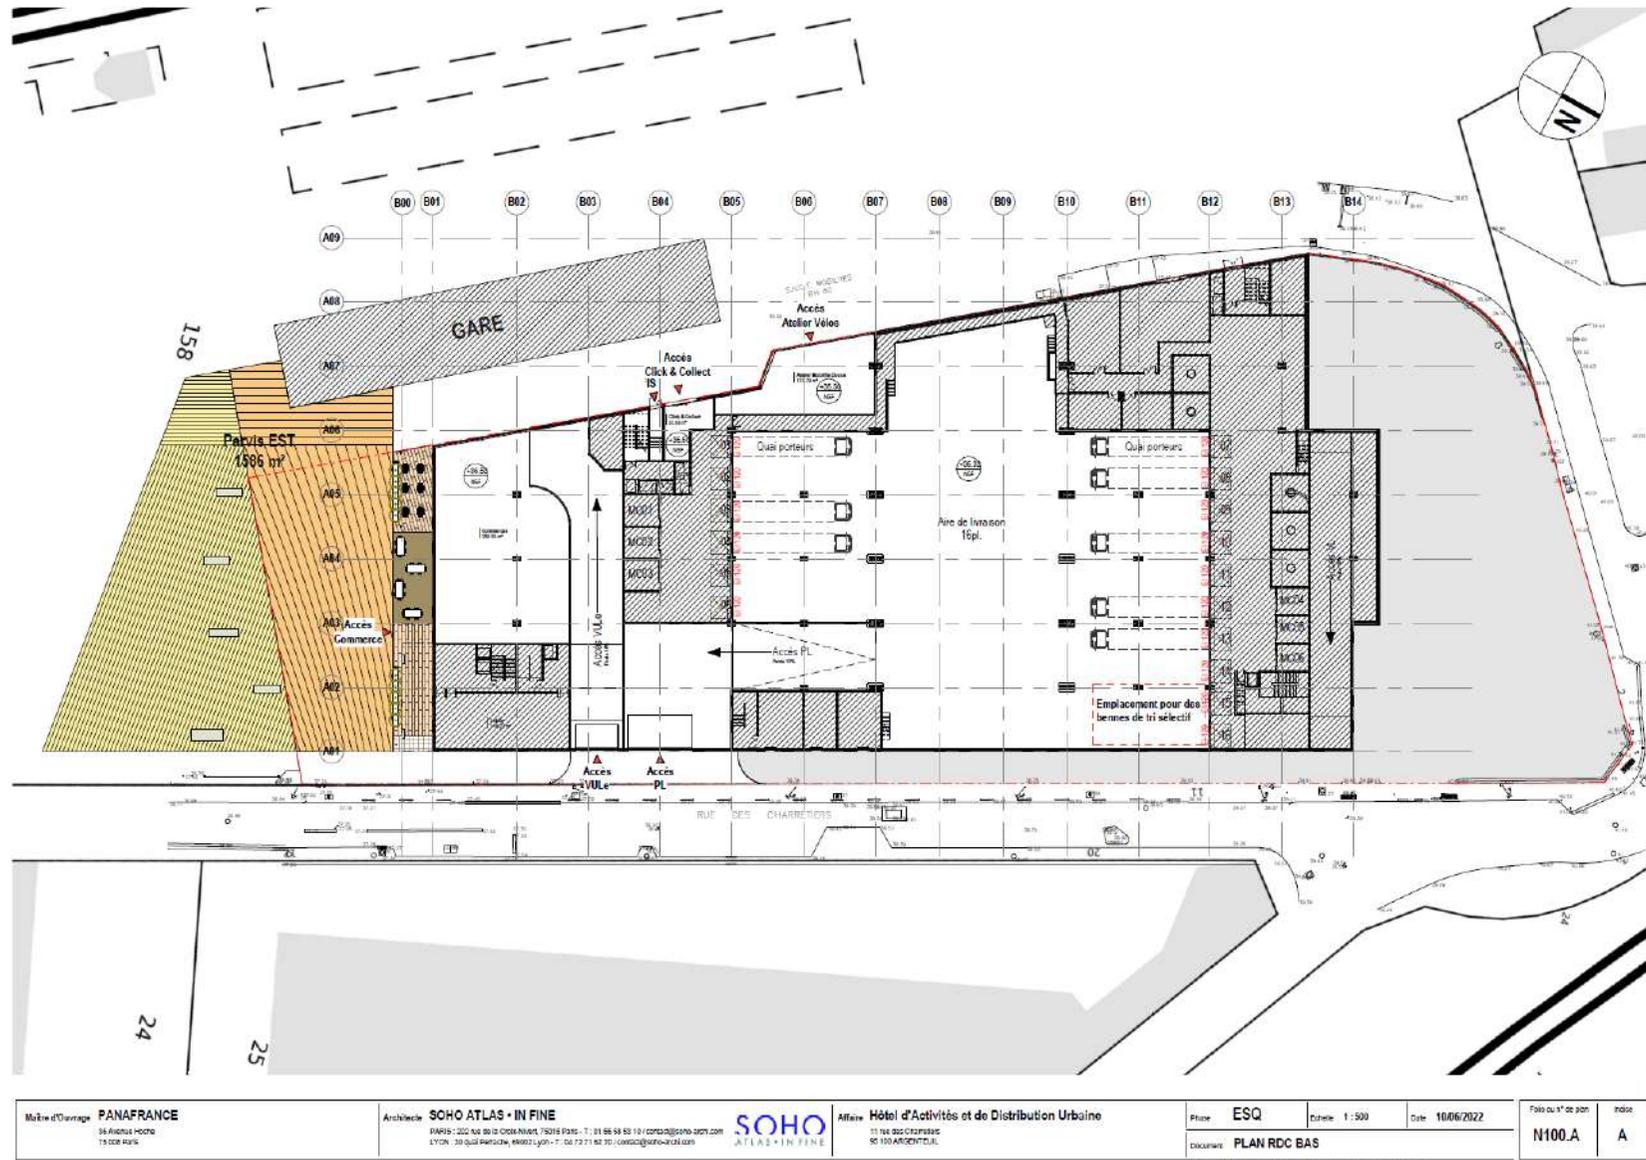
Plan de masse du RDC Bas (source :SOHO ATLAS IN FINE)
